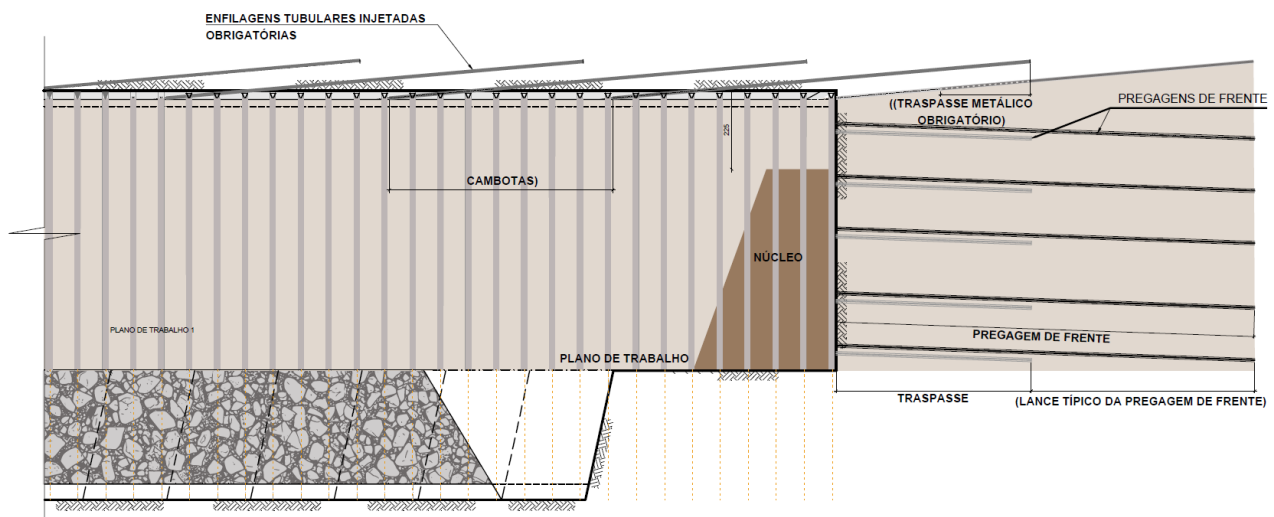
Exemplo de enfilagens em seção constante (perfil longitudinal)
